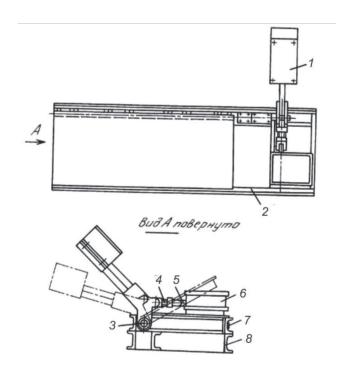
Устройство для ограждения железнодорожного переезда: 1 — противовес; 2 — крышка; 3 — ось крышки; 4 — тяга; 5 — шибер; 6 — привод; 7 — светоотражающие пластины; 8 — опорные основания
